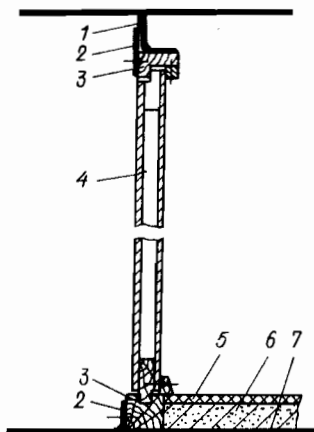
Конструкция легкой выгородки (поперечное сечение).
